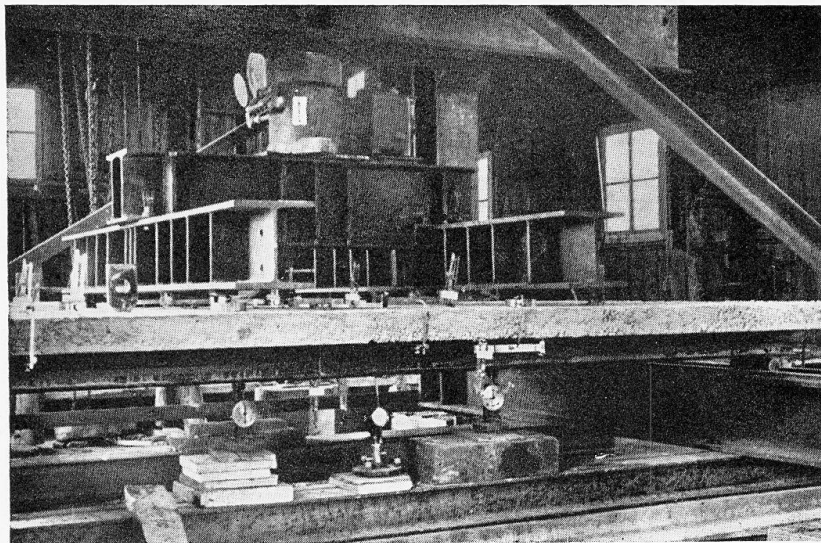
Dispositif d'essai avec poutres, avant l'essai.
